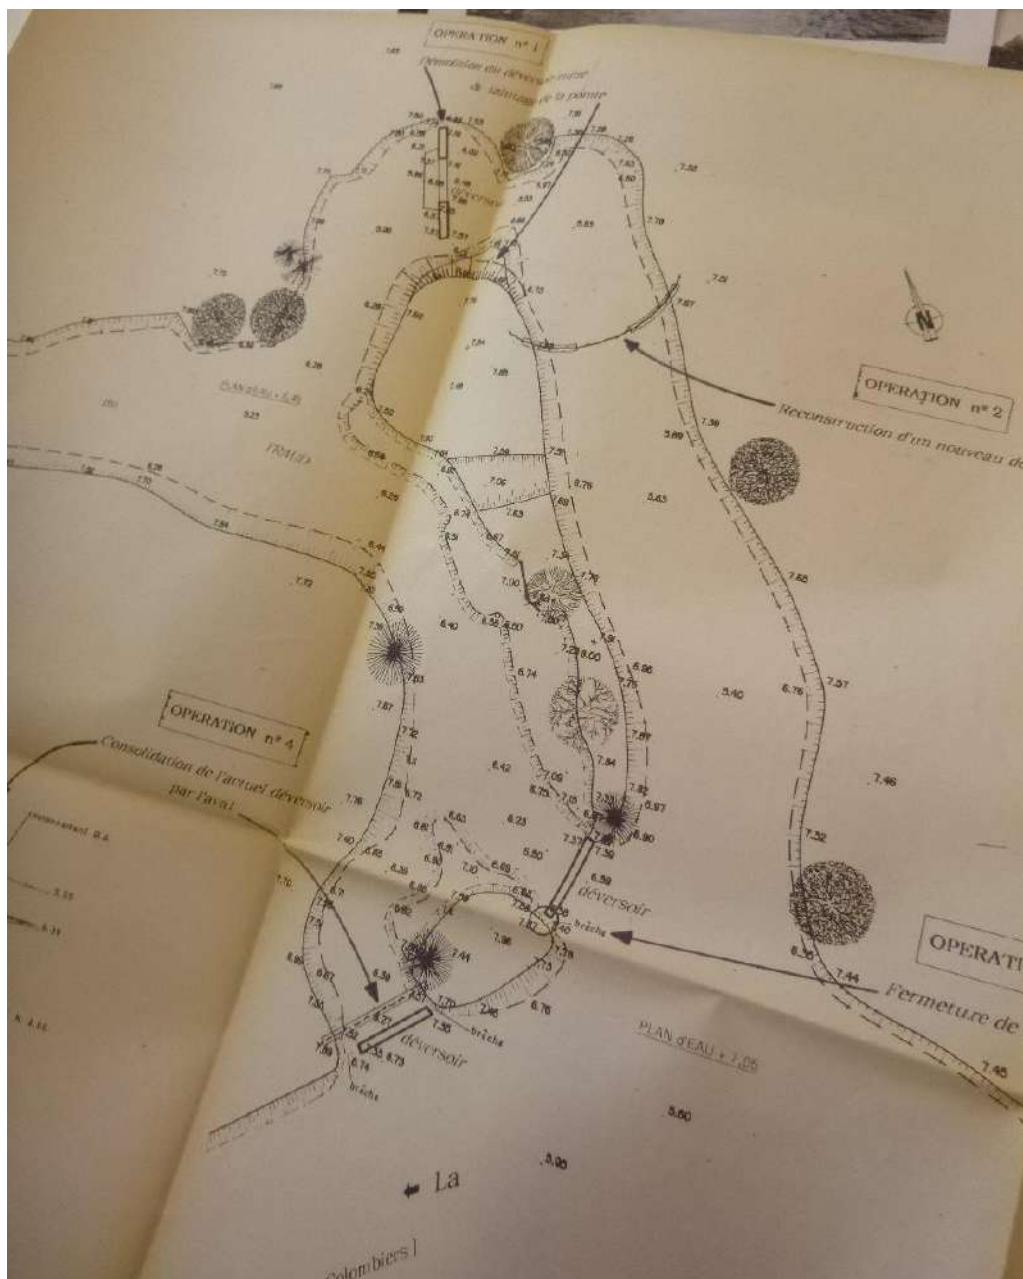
Vue en plan des déversoirs du Liaumet en amont du Moulin de Mérignac (UNIMA)
